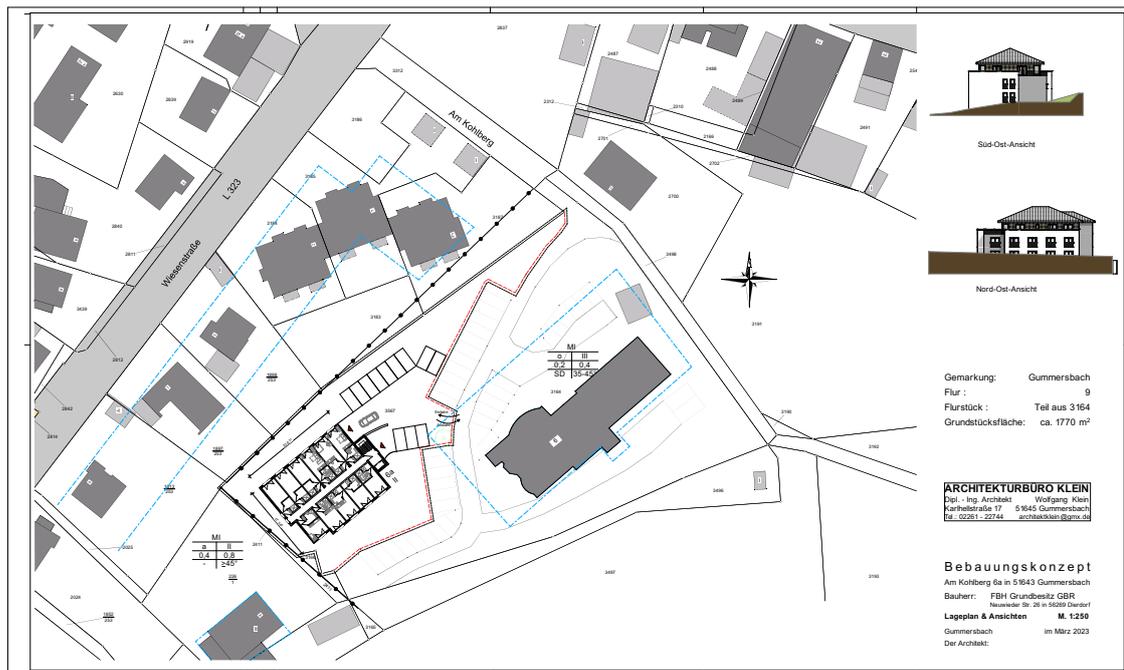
Mögliches Planungskonzept für den Neubau im Plangebiet (Quelle: Architekturbüro Klein, 2023)
